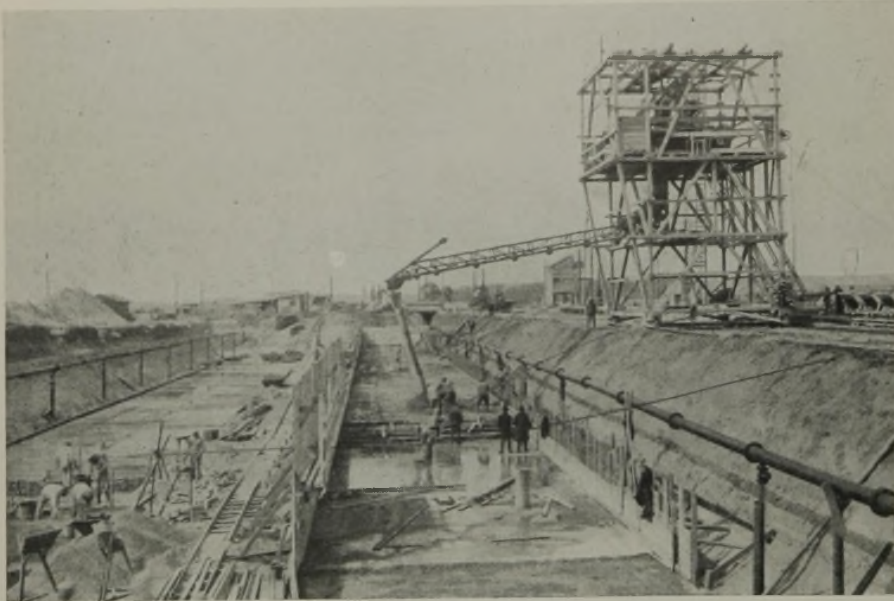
Herstellen der Schutzschicht unter dem Bauwerk und Turmgerüst für die Betonfabrik.
